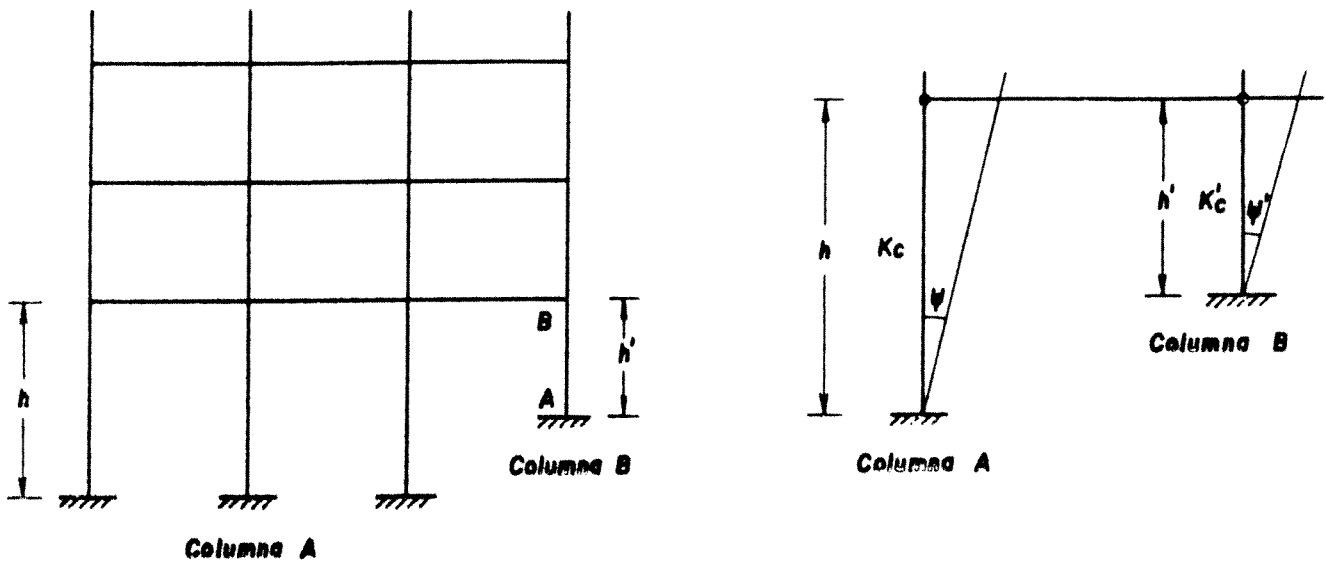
DETERMINACION DE "a" PARA EL CASO DE COLUMNAS DE DISTINTA ALTURA EN PLANTA BAJA
